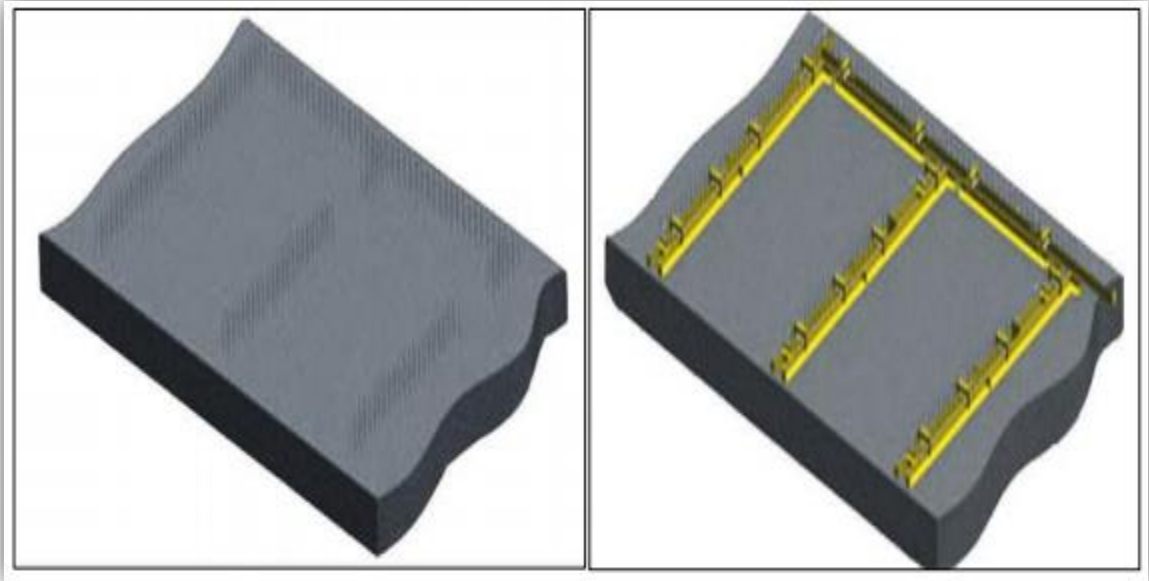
1<sup>ère</sup> étape du coffrage tunnel.
